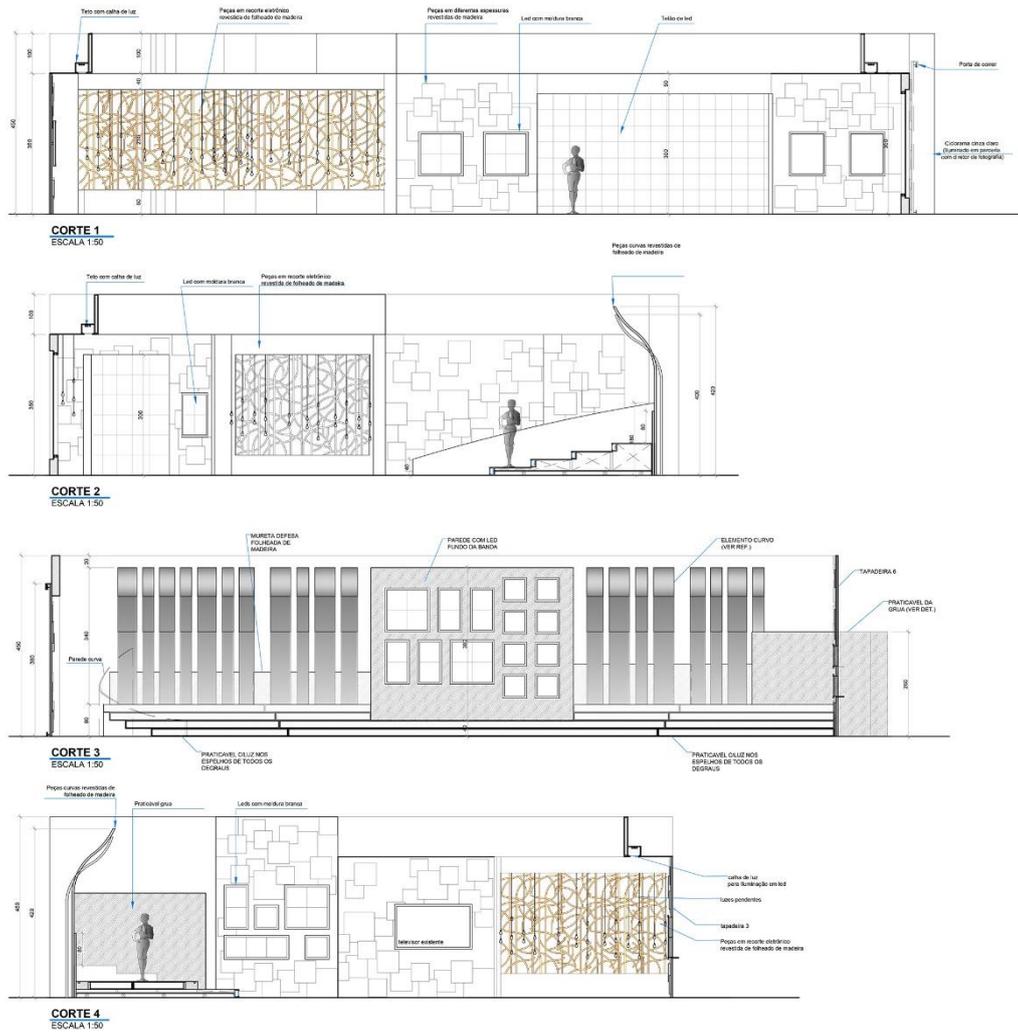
Desenho técnico do cenário inserido no estúdio – planta baixa contendo todas as informações importantes para a execução do cenário. Fonte: arquivo pessoal.
